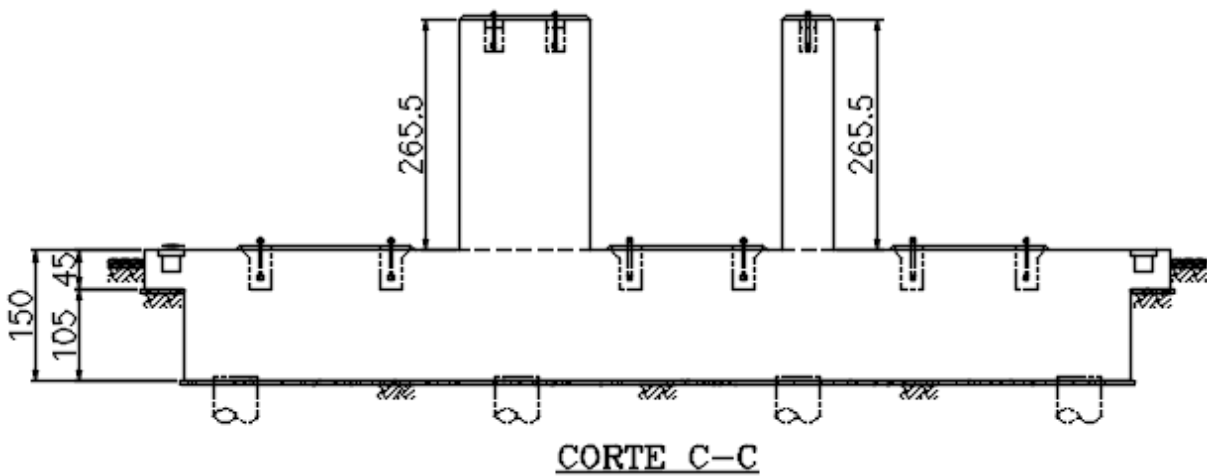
Modelo estrutural: elevação da fundação (Corte C-C)
